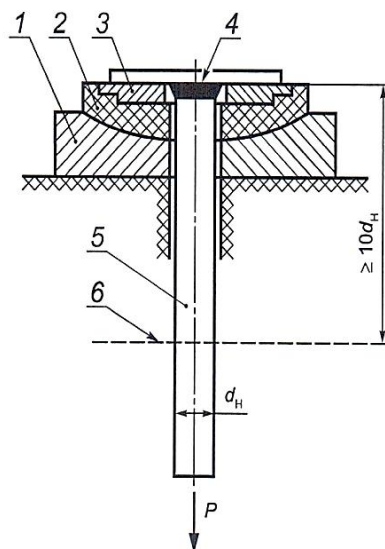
Схема испытания тавровых соединений анкерных стержней закладных изделий на отрыв: d_n – номинальный диаметр анкерного стержня; P – испытательная нагрузка; 1 – сферическая опора; 2 – сферический вкладыш; 3 – сменное опорное кольцо; 4 – плоский элемент закладного изделия; 5 – анкерный стержень; 6 – граница закрепления в захвате разрывной машины
